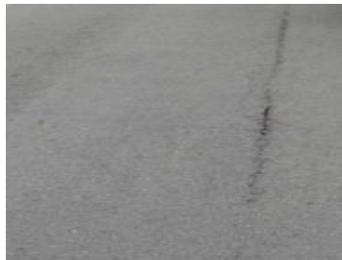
Fisura Longitudinal en Junta de Construcción
